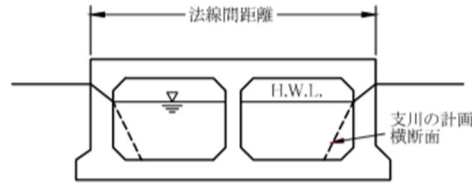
樋門の断面説明図（流下断面積が1:1.3以内の場合）
